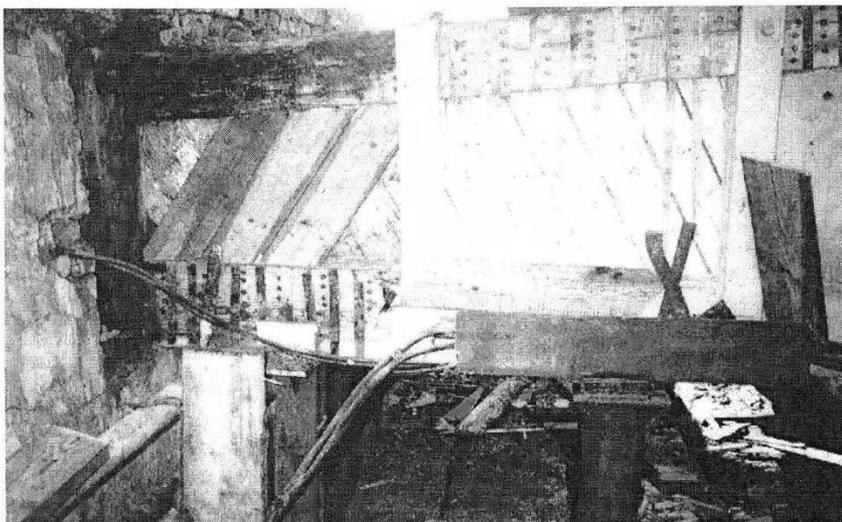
Загнивание опорной части деревянной балки с перекрестной дощатой стенкой на гвоздях (из-за нарушения водостока с кровли после пристройки слева более высокого здания)
